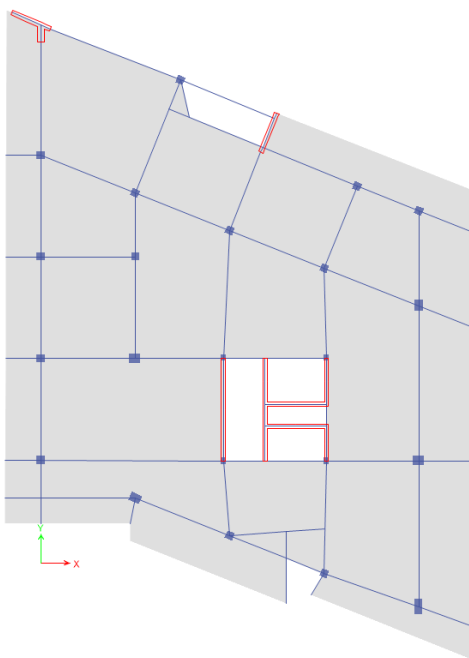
Distribución de elementos estructurales en planta (Losa Niveles 2 - 7)
